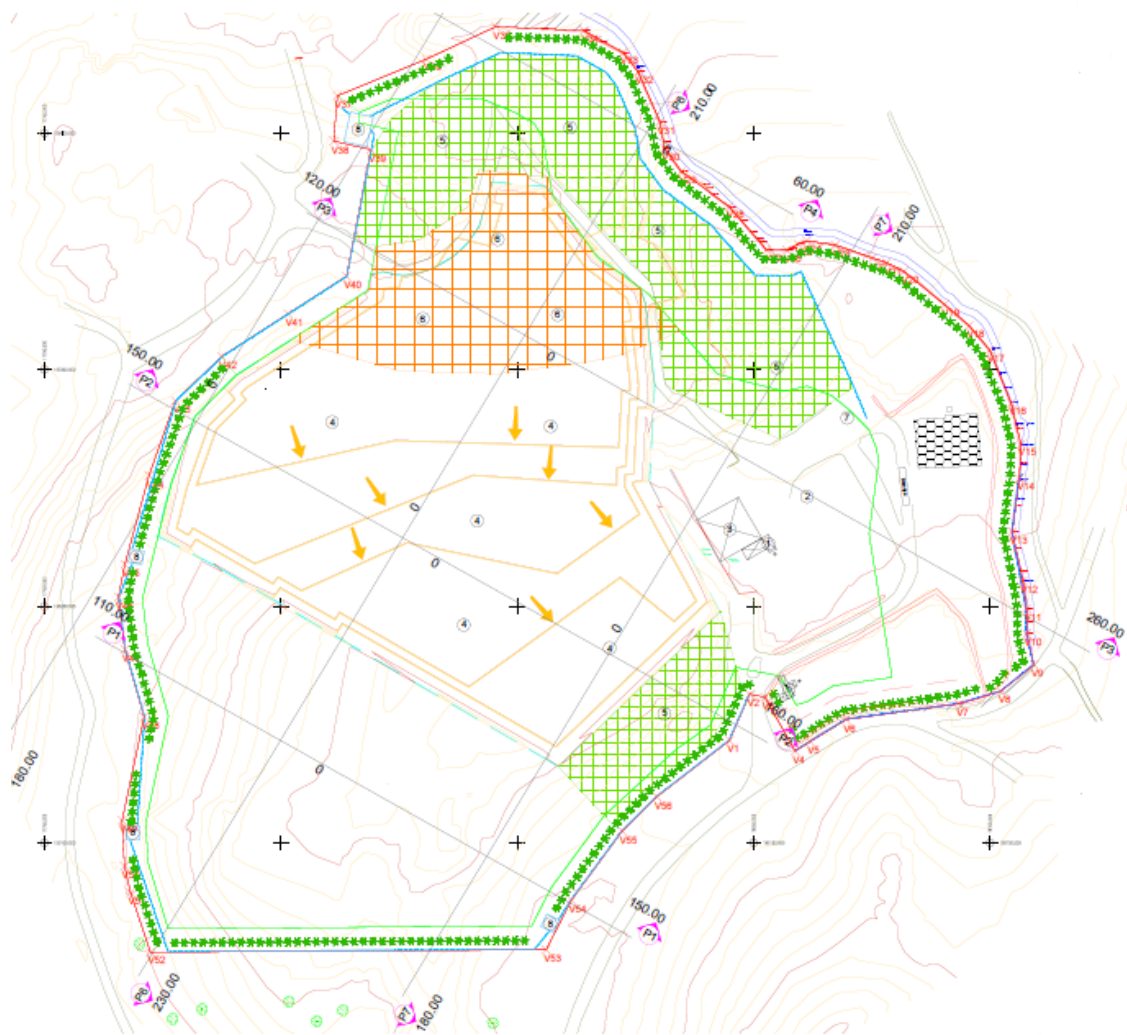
Planta de escavação – Exploração a 10 anos.
